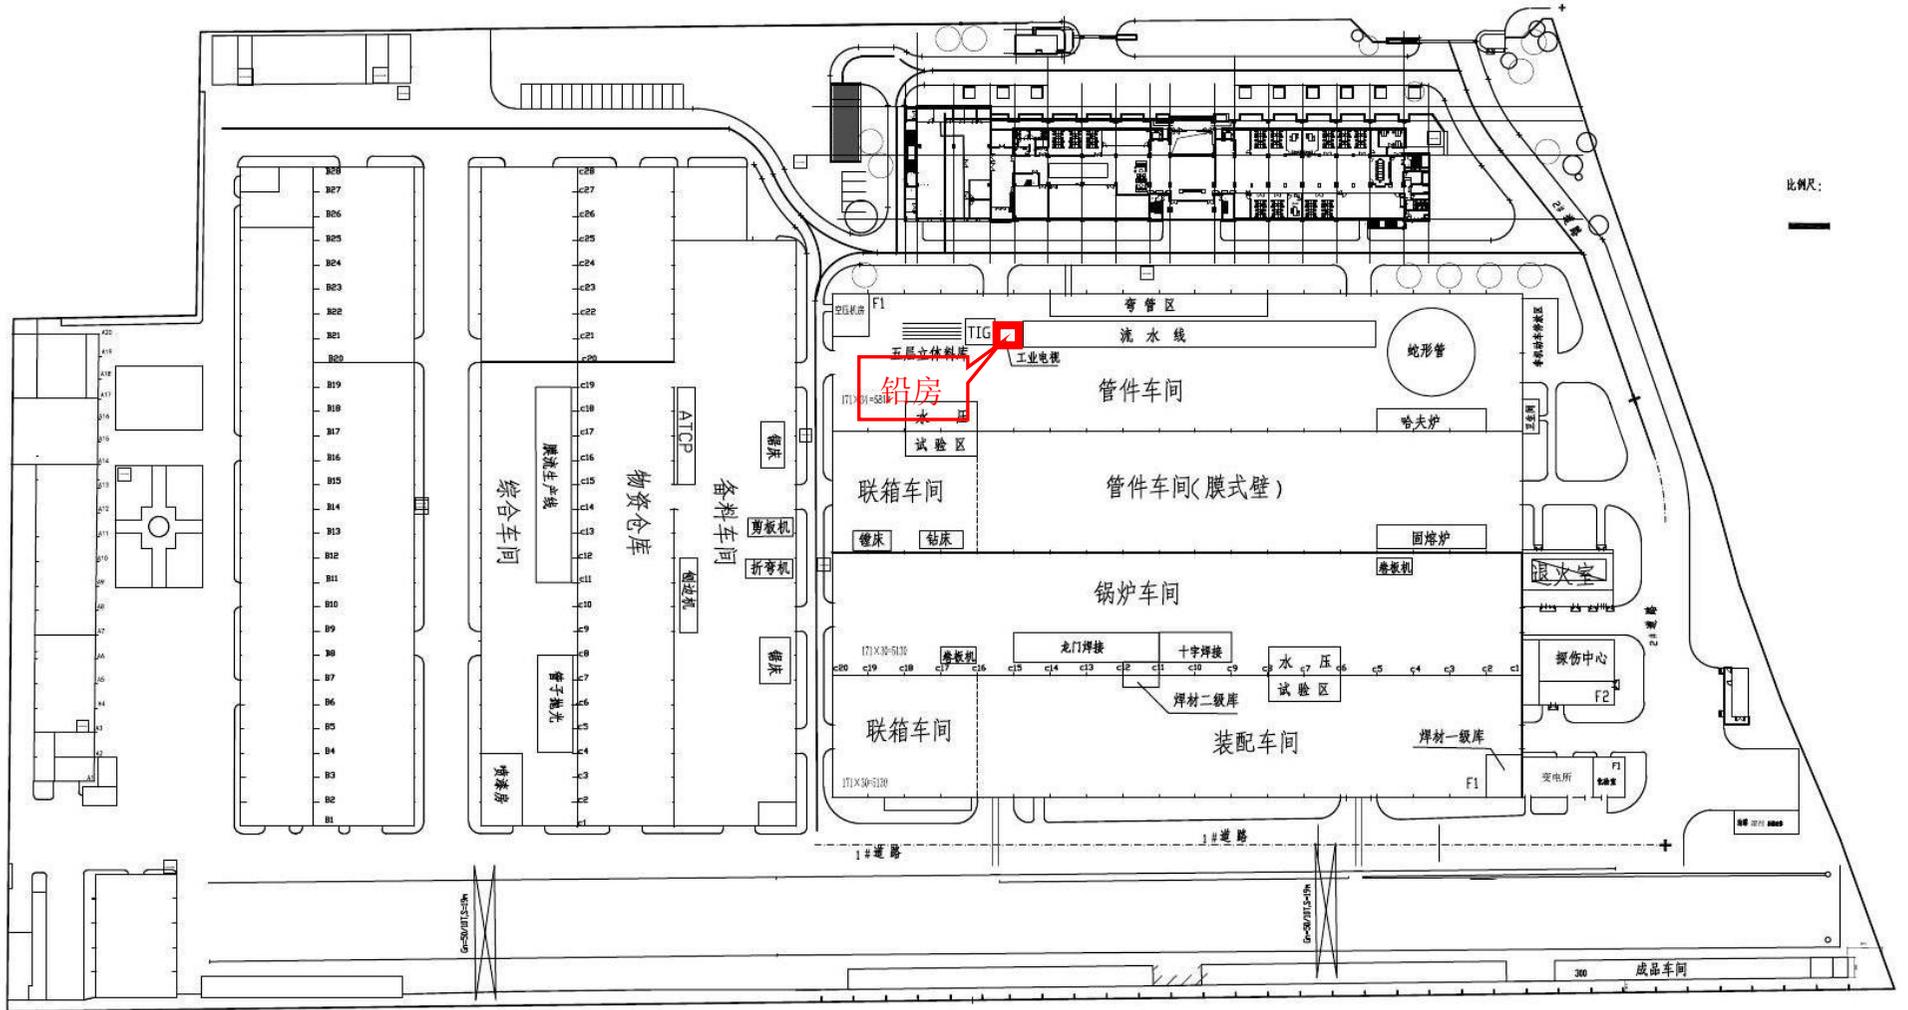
杭州杭锅工业锅炉有限公司厂区平面布置图
